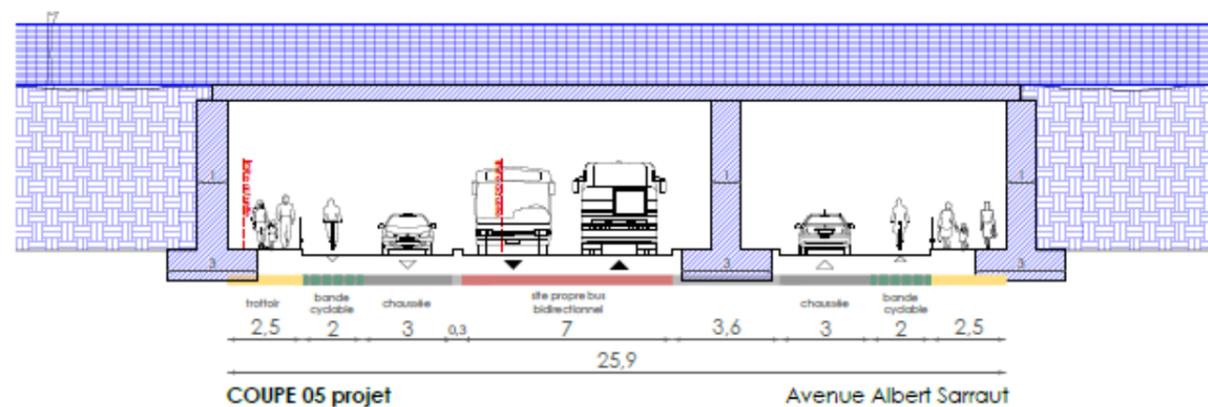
profil projeté au droit du franchissement des ouvrages de l'avenue de la Gare
